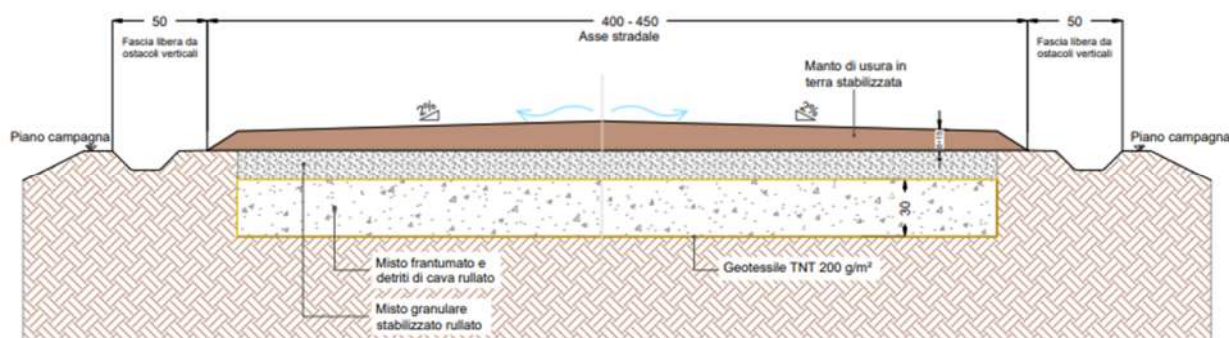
Sezione tipo pista di impianto a livello; misure in centimetri
